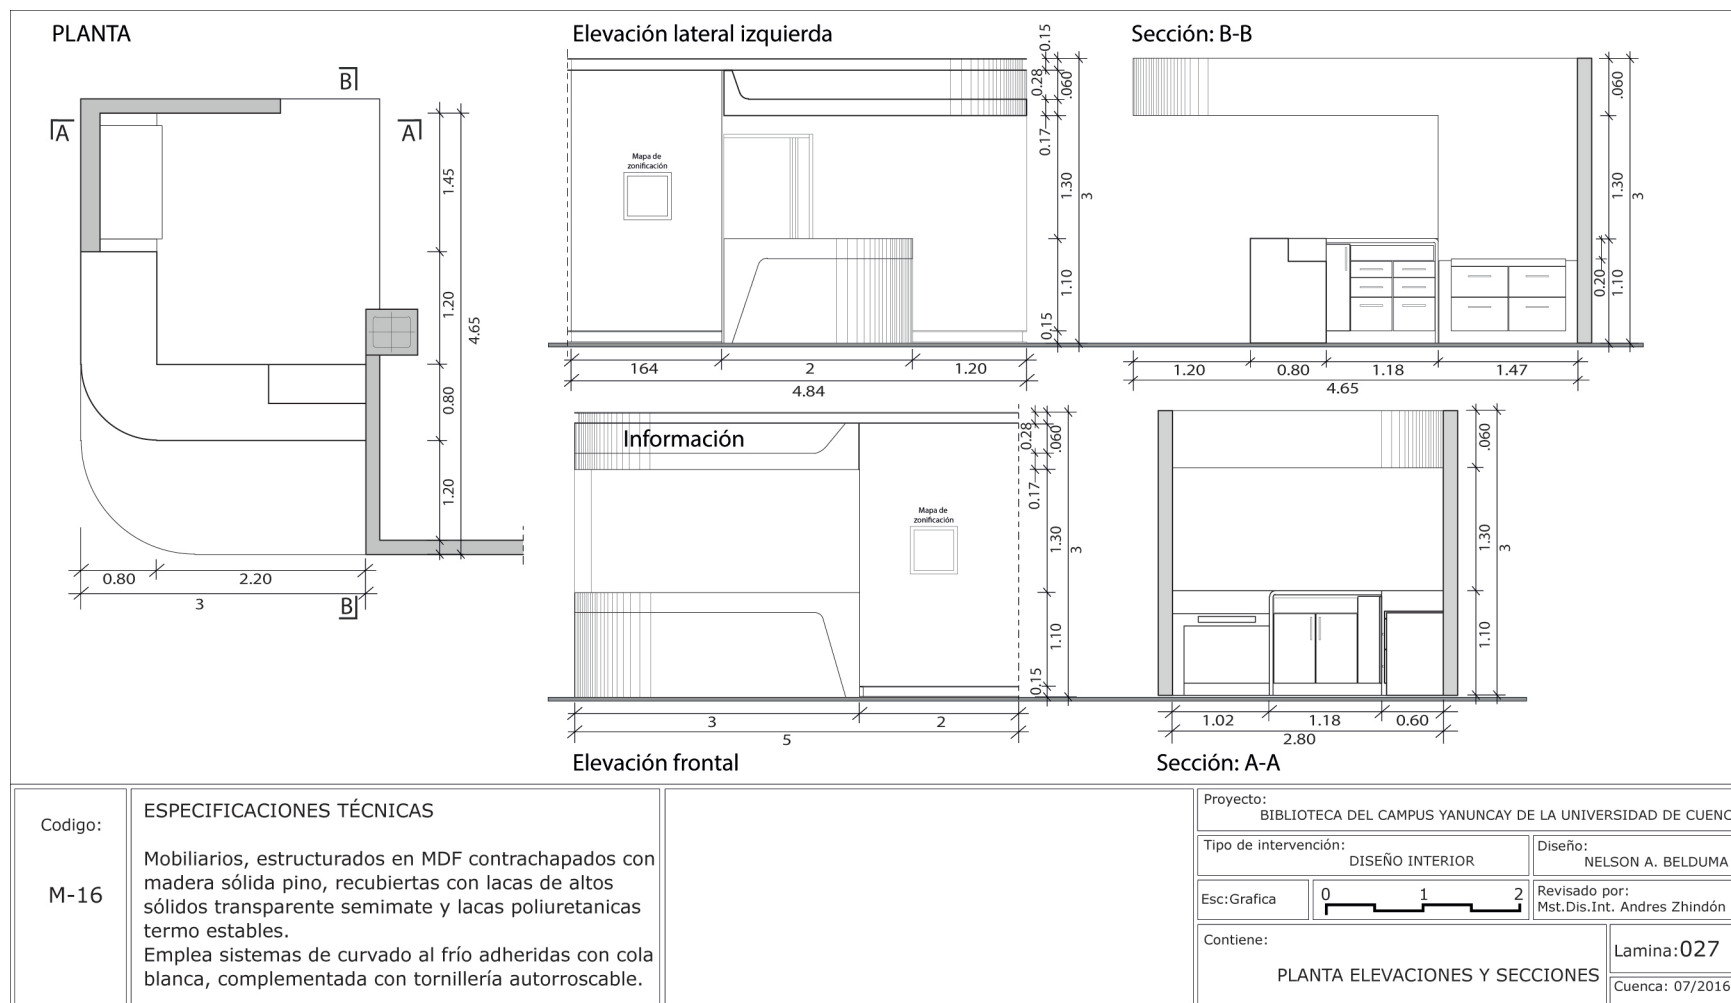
Planta, elevaciones y secciones. Counter de atención al público. M-16.
